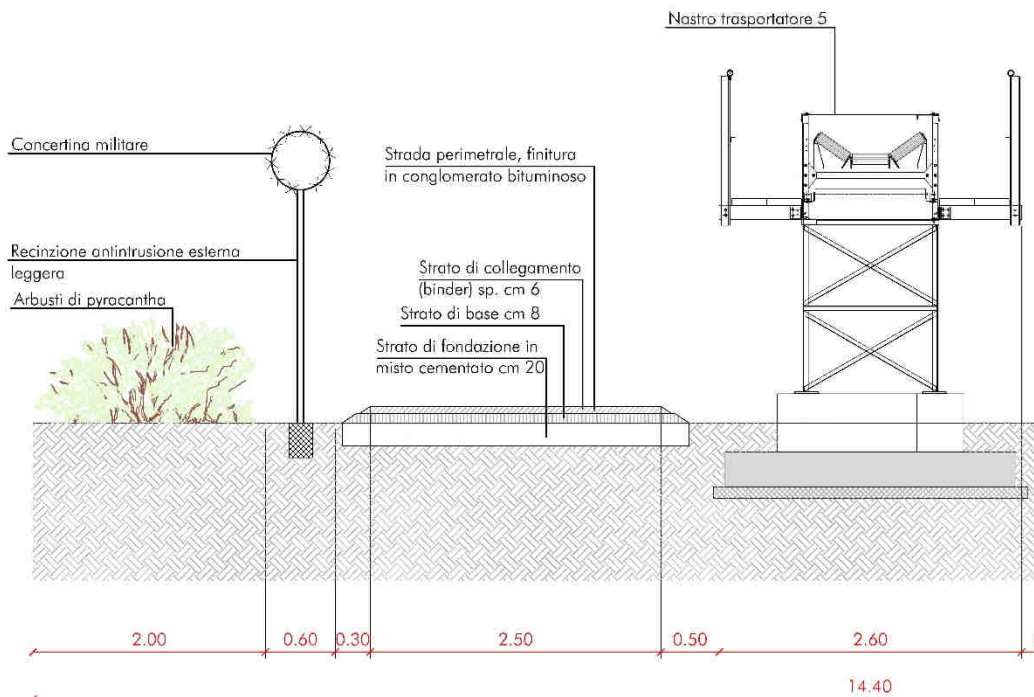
Sezione tipologica apprestamenti security lungo nastro 5
